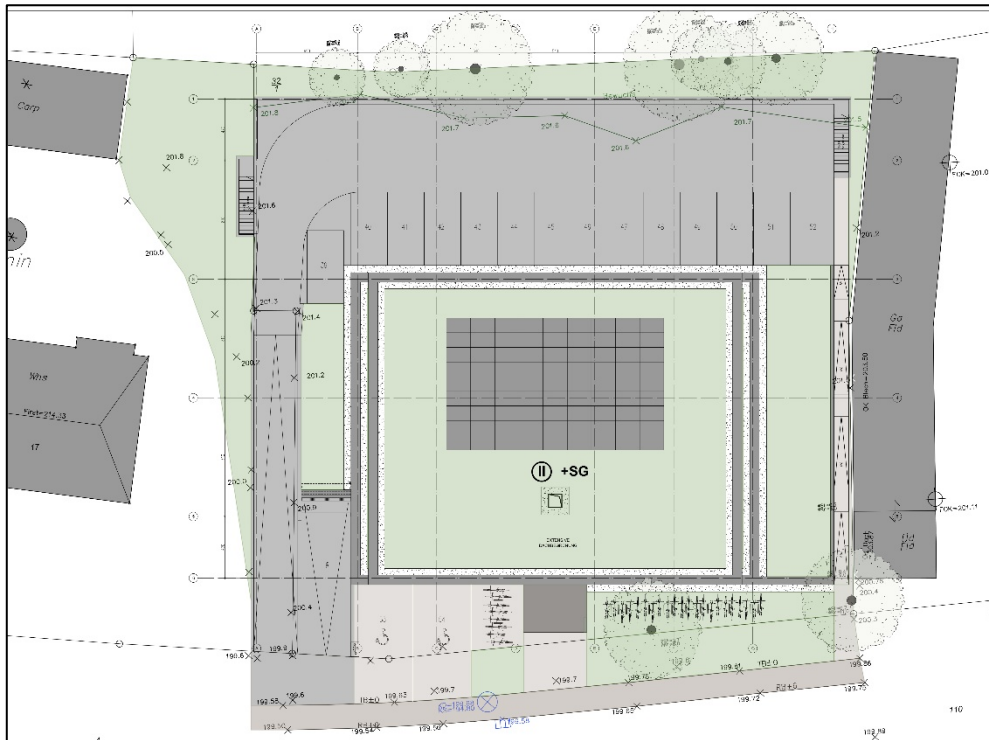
Dachaufsicht Entwurfsplanung vom 26.06.2025
